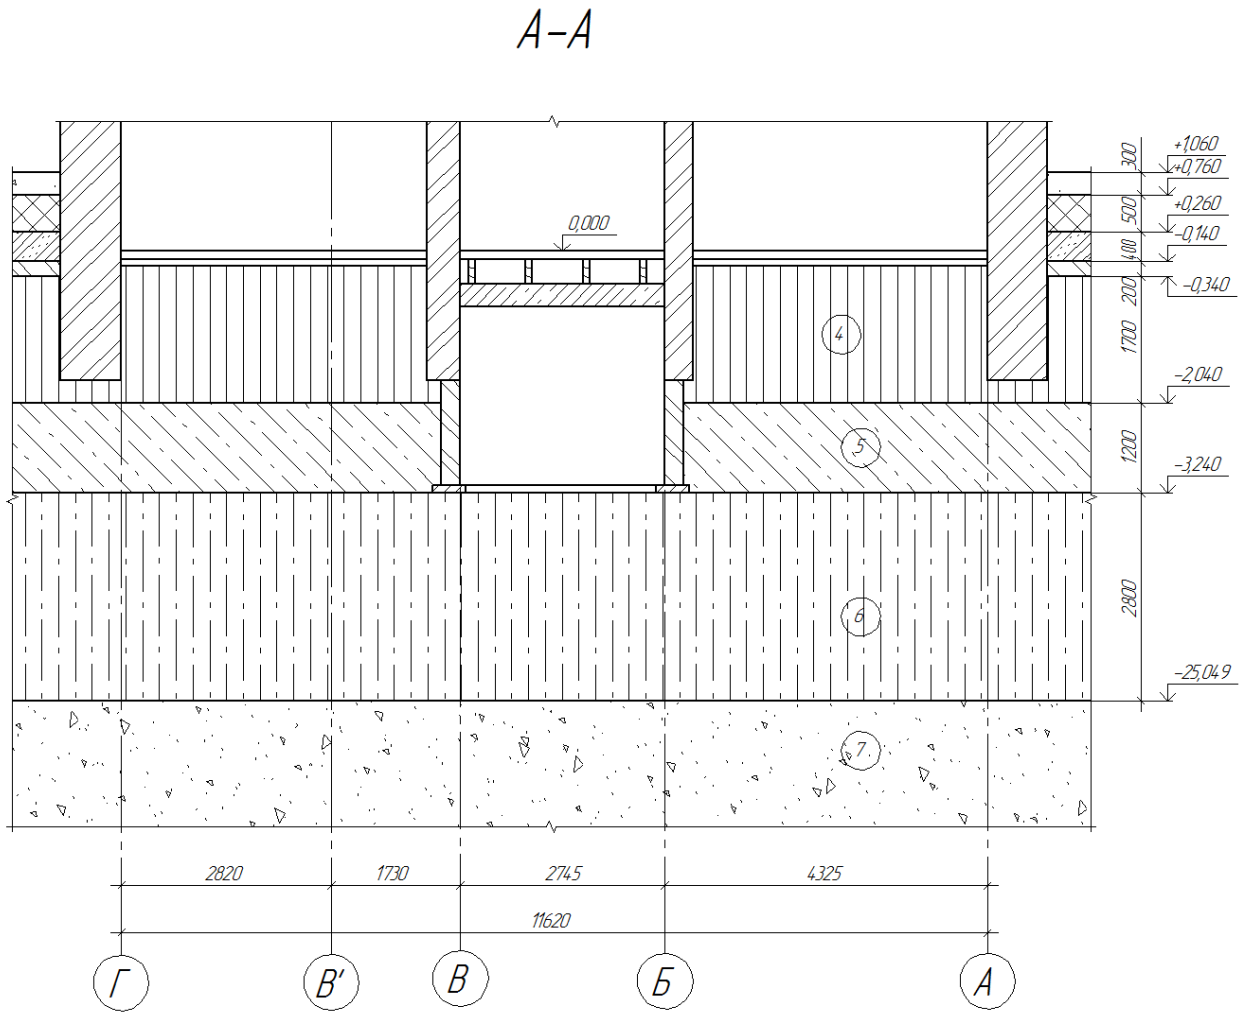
Конструктивна схема фундаментів будівлі та стін підвалу.
